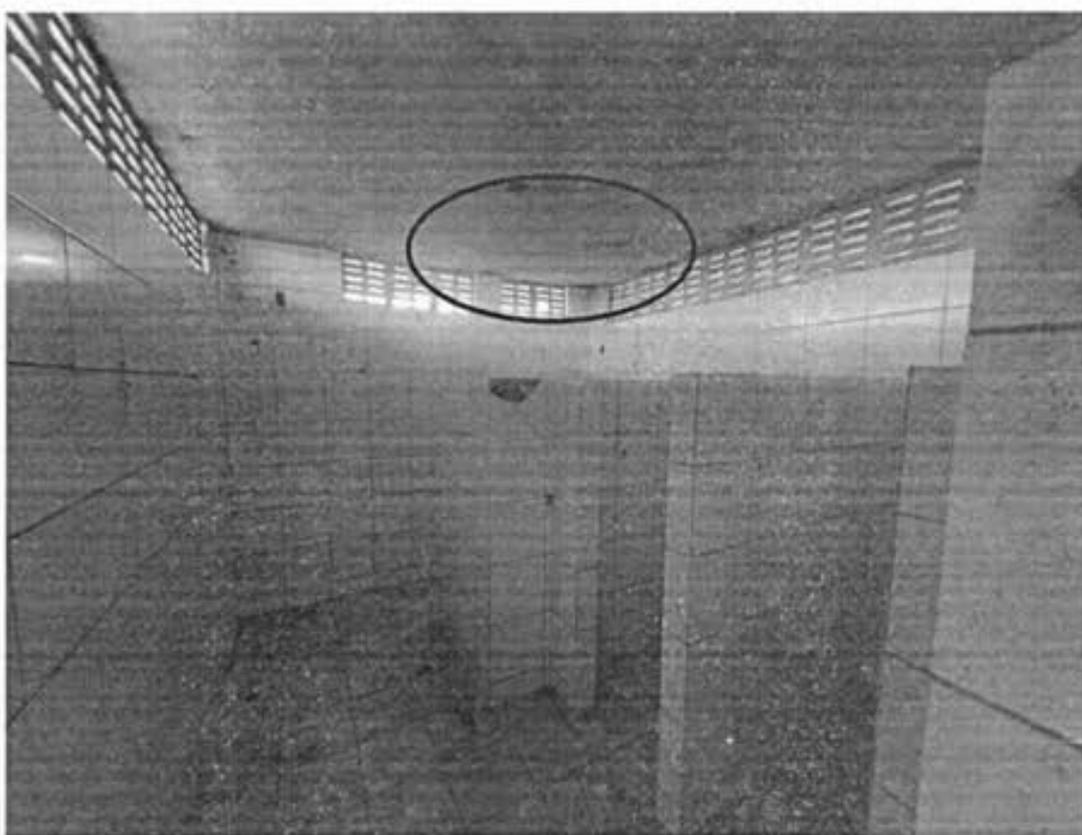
Vestiário - Fissuras no revestimento da laje (reboco)
